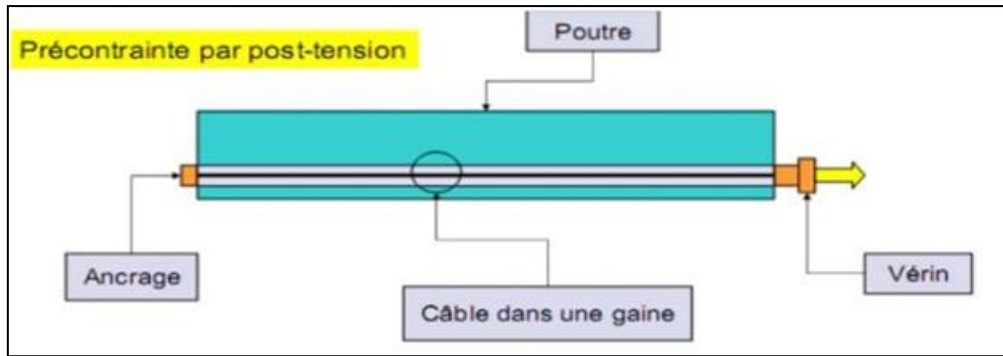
Coupe longitudinale d'une poutre en béton précontraint par post-tension.
